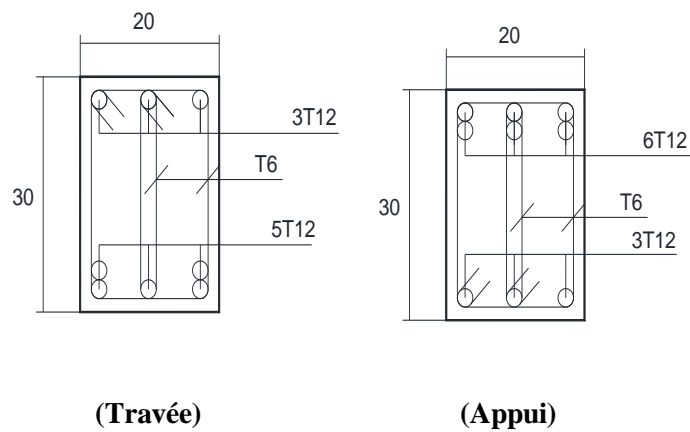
Ferrailage d'une poutre noyée secondaire 20x30cm (plan irrégulier en élévation)
